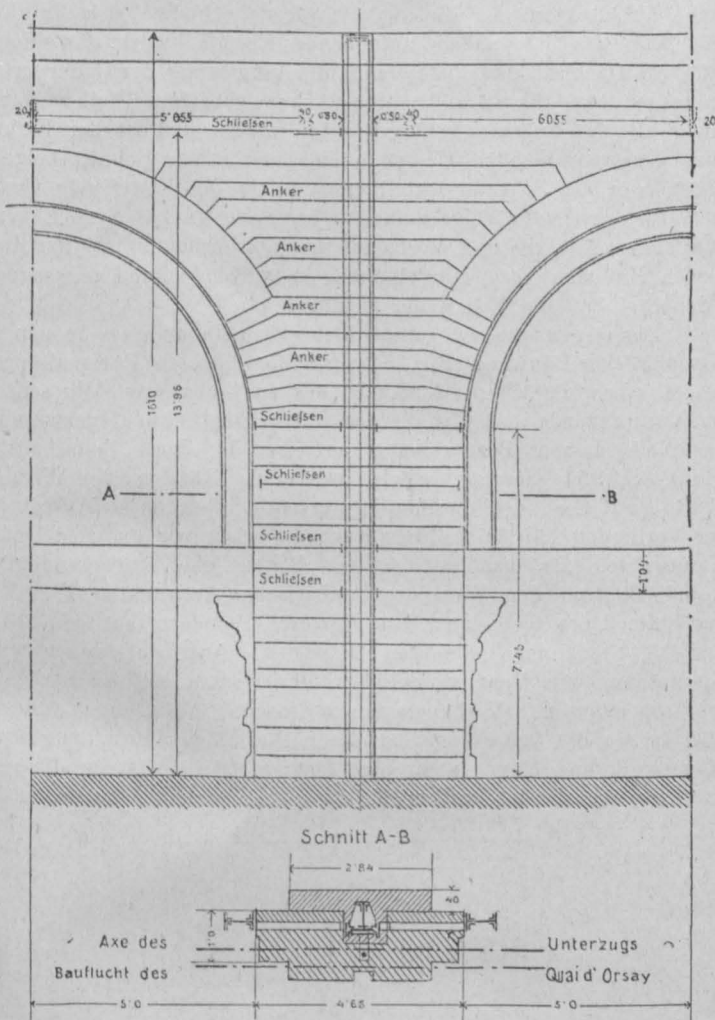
Orléansbahnhof in Paris. Rückansicht eines Façadenpfeilers. Eisenfachwerk mit Mauerwerkshülle.
